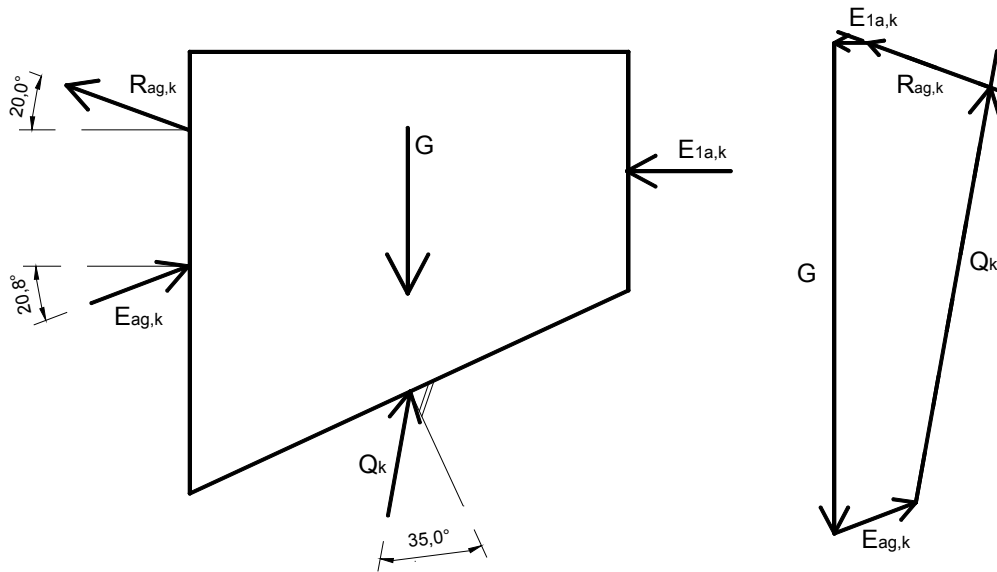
Lage- und Kräfteplan bei Ansatz ständiger Lasten
